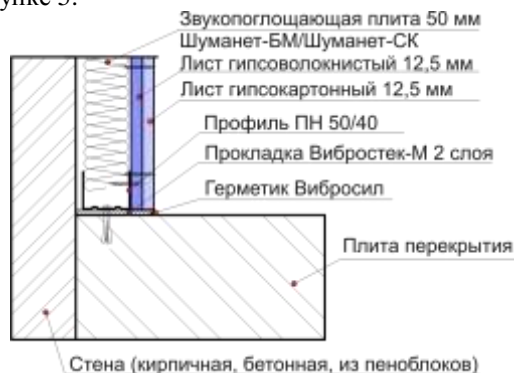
Примыкание облицовки стены на независимом каркасе 75 мм к перекрытию
